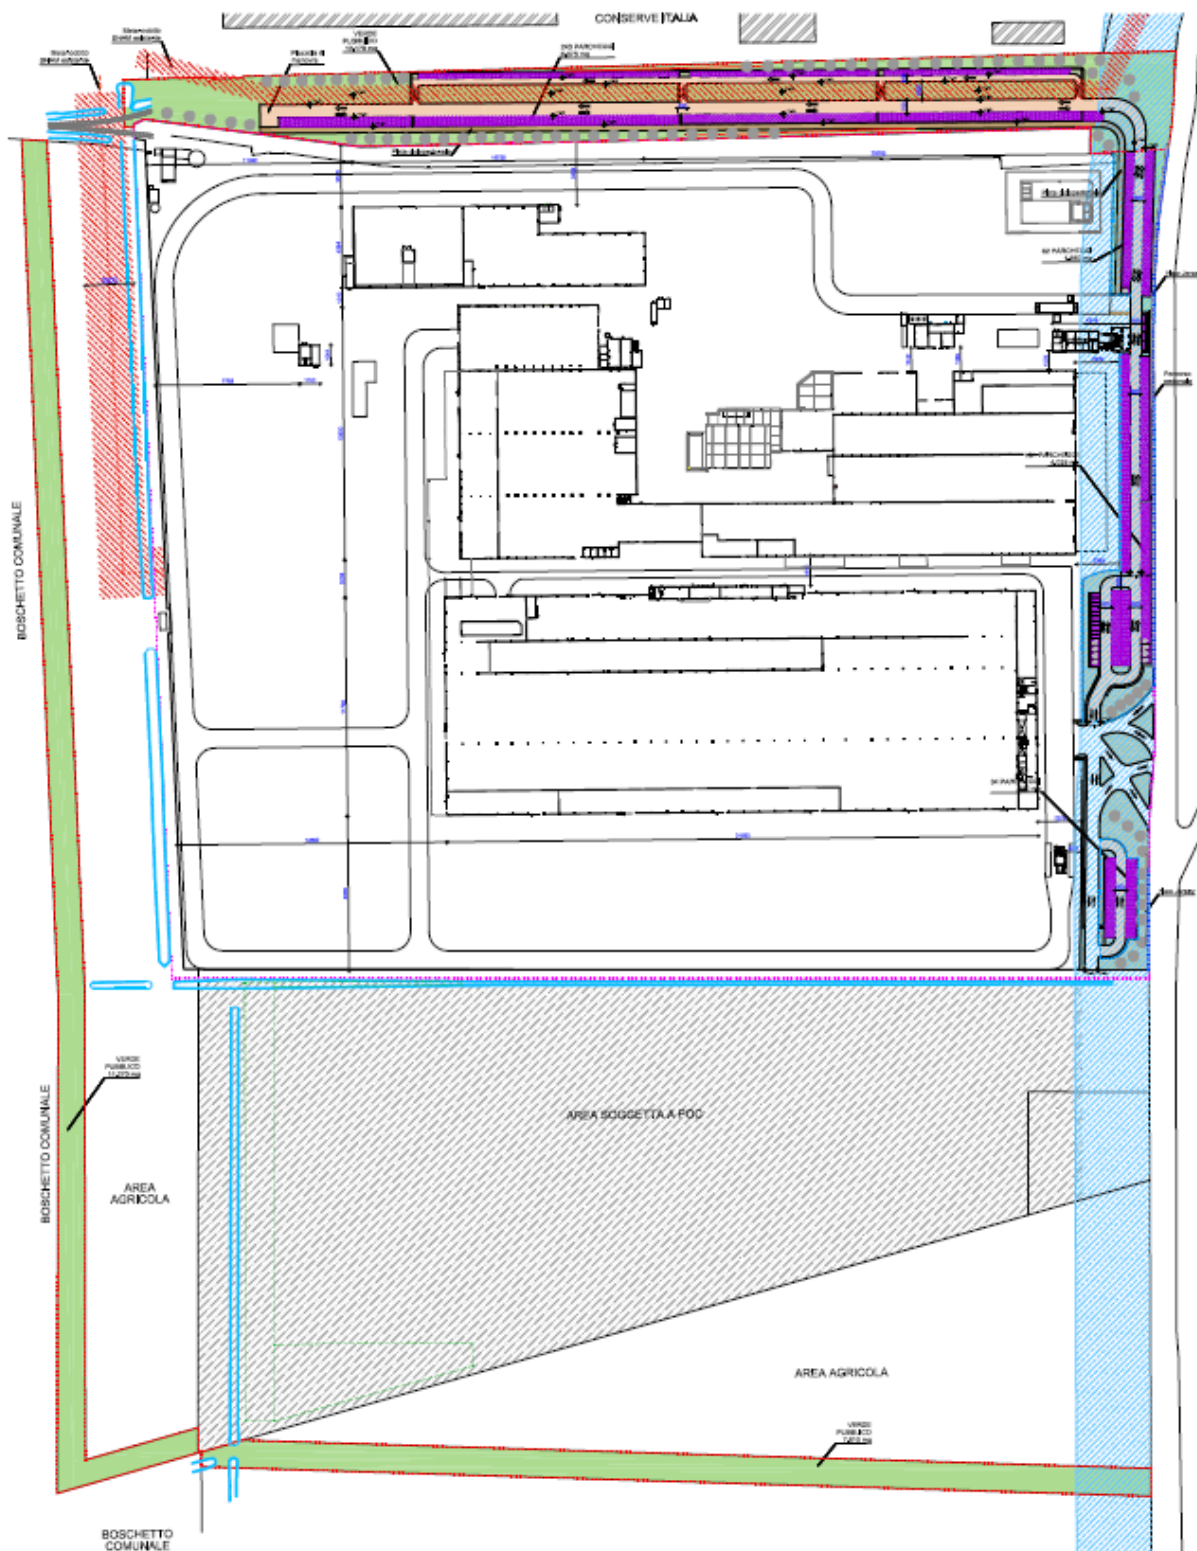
S1 – Variante PIP : Tav. U03a – Stato di Progetto: Planimetria Generale
